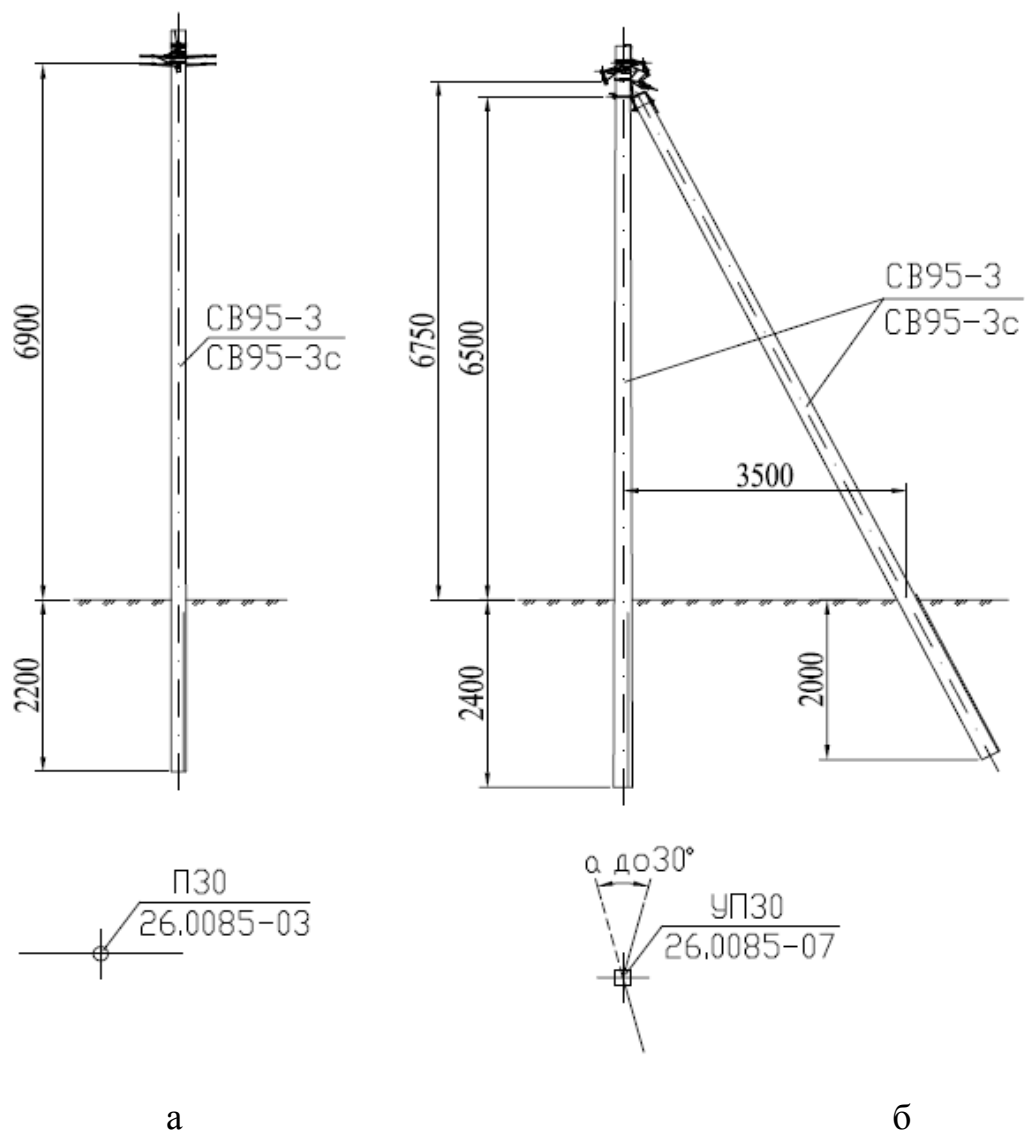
Конструкции двухцепных железобетонных опор для ВЛИ 0,38 кВ: а – промежуточная; б – угловая промежуточная
